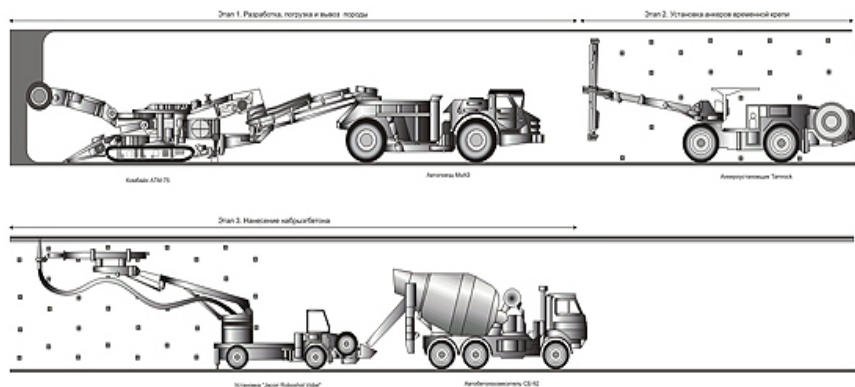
Проходка тоннеля комбайном в устойчивых породах с креплением анкерами и набрызгбетоном
